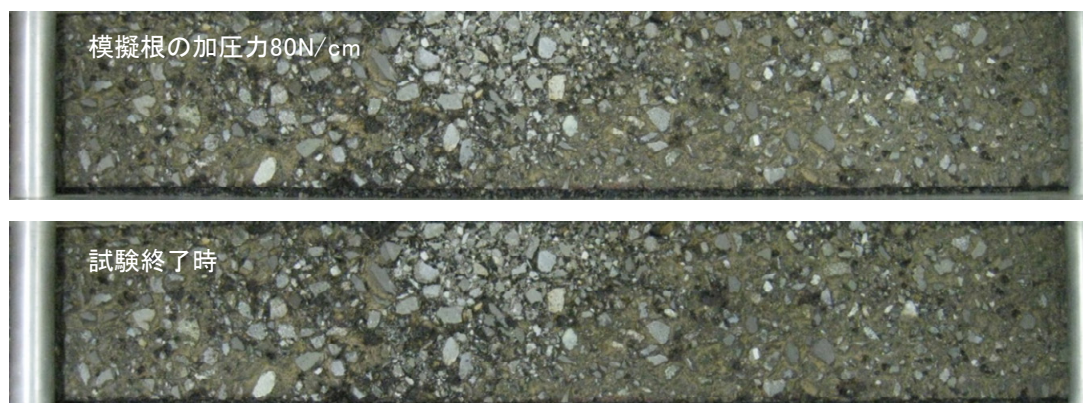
アスファルト舗装表面のひび割れ状態の一例(模擬根直上の砂層の厚さ50mm) 3/3
